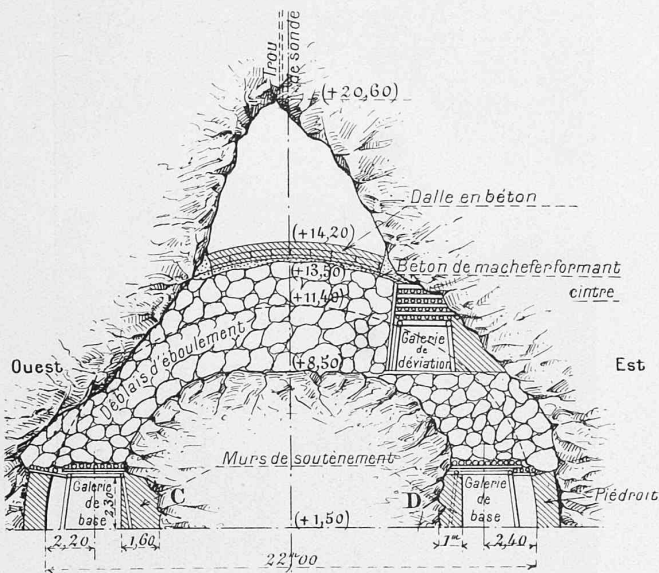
Querschnitt durch den Ring Nr. 103 während der Erstellung der gewölbten bewehrten Betondecke.
